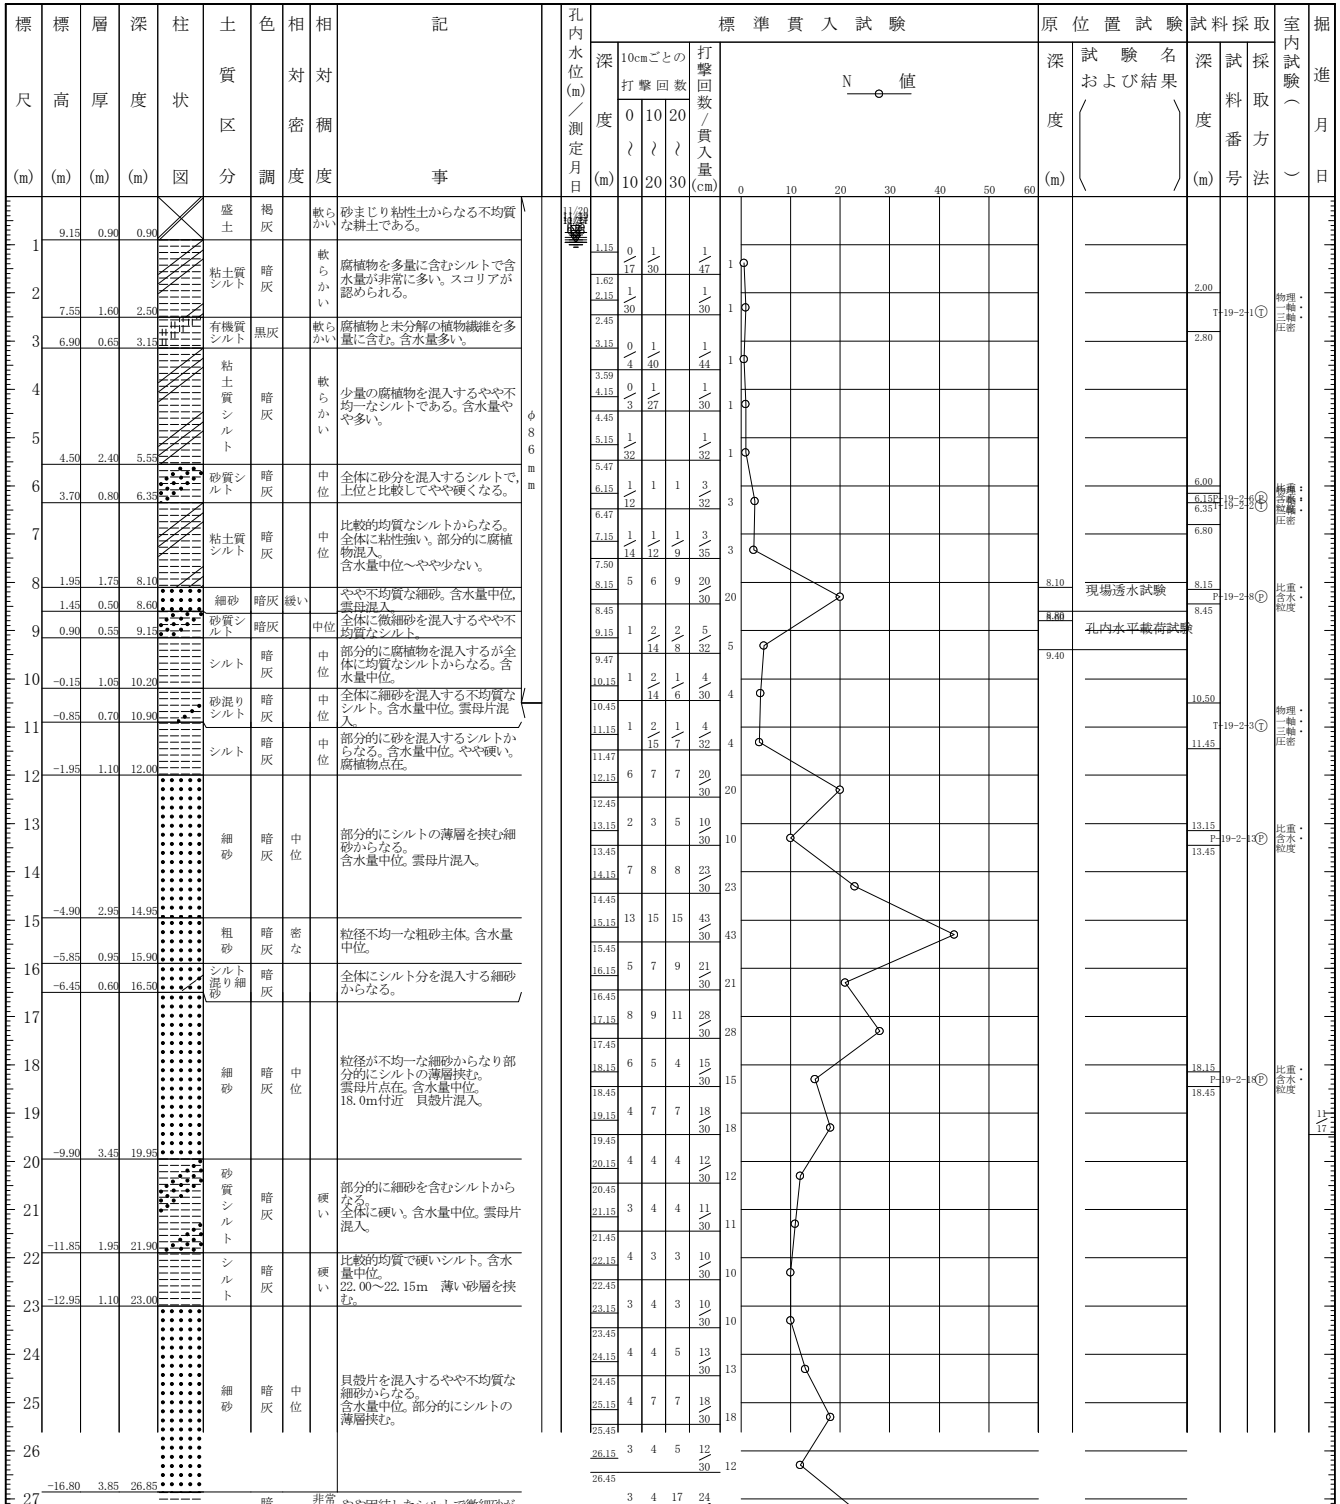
(2) ボーリング柱状図 (No.2-2)
